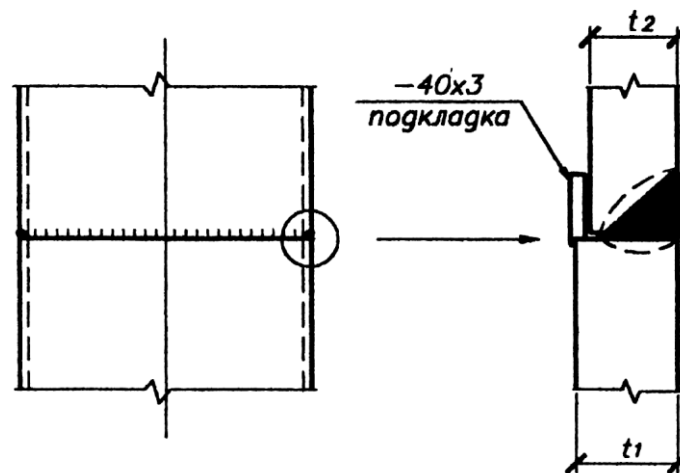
Фрагмент сварки стыков поясов колонн
